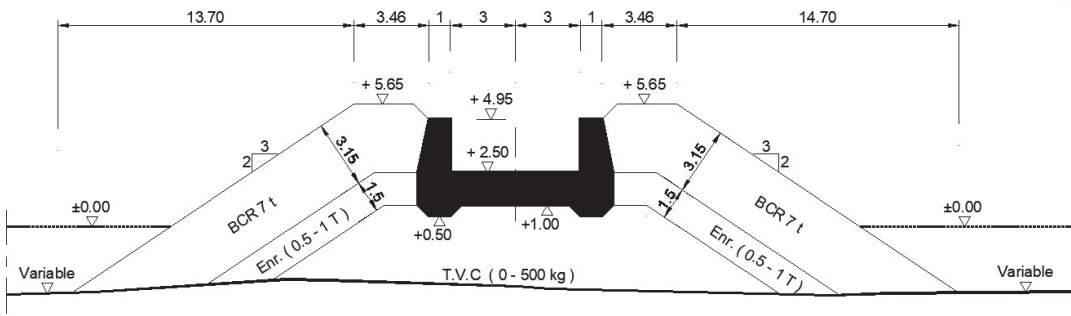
Coupe transversale du profil musoir de la jetée secondaire
